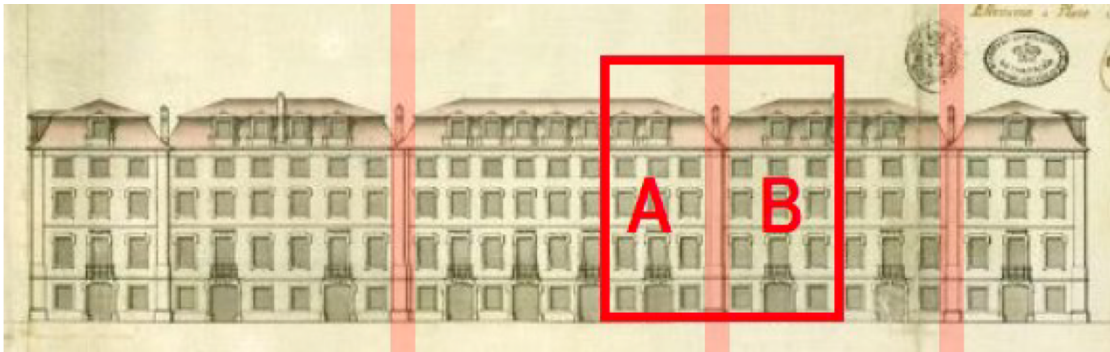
Fachada para a Praça D. Pedro IV separadas por uma parede corta-fogo.
